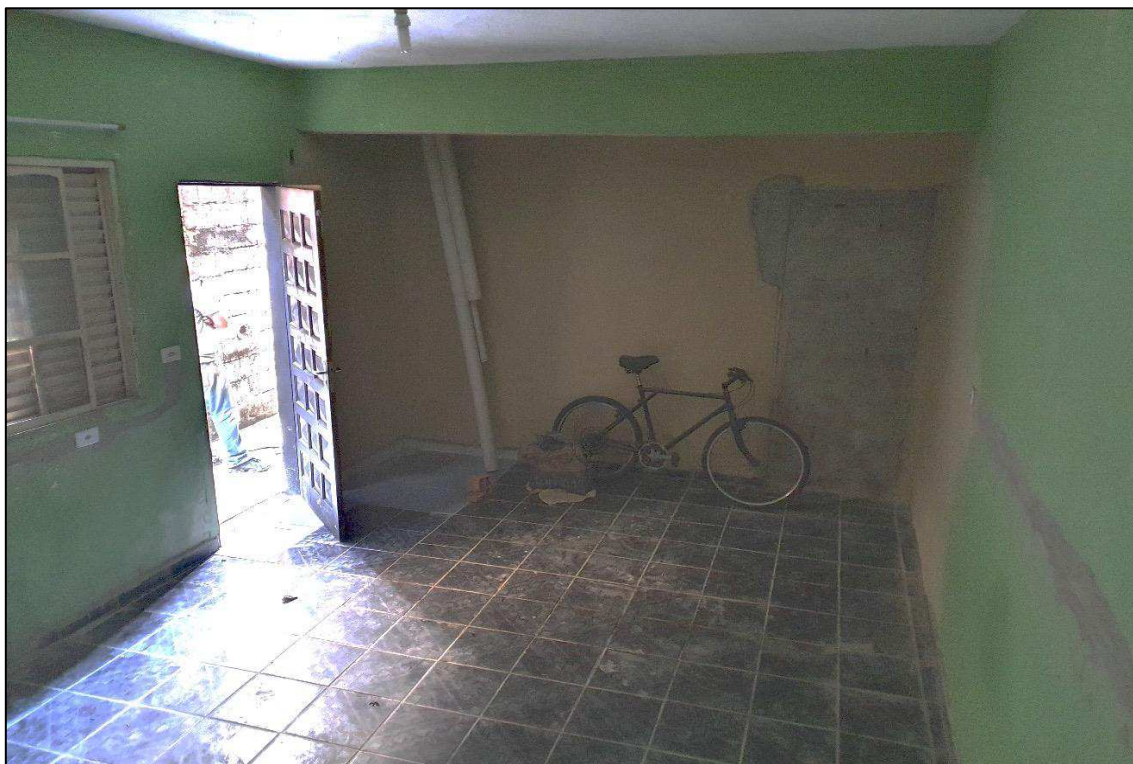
Vista do interior da casa 01 (cozinha)
